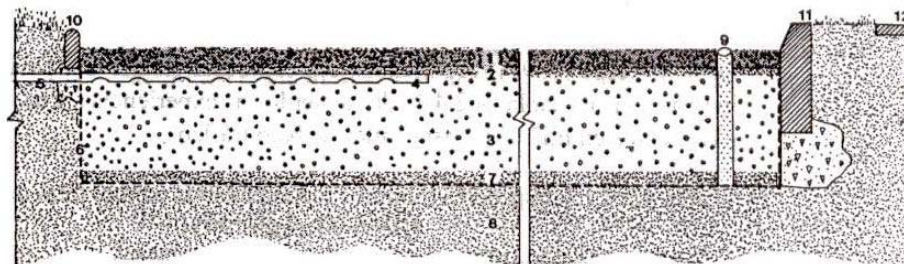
1.- Carpeta de rodado de asfalto o concreto poroso, 2.- Base o filtro granular graduado, 3.- Subbase de grava o ripio uniforme, 4.- Tubería de drenaje (opcional), 5.- Tubería exterior, 6.- Filtro geotextil, 7.- Filtro granular (opcional), 8.- Subrasante, 9.- Tubo piezométrico (opcional), 10.- Solerilla, 11.- Solera, 12, Vereda.
